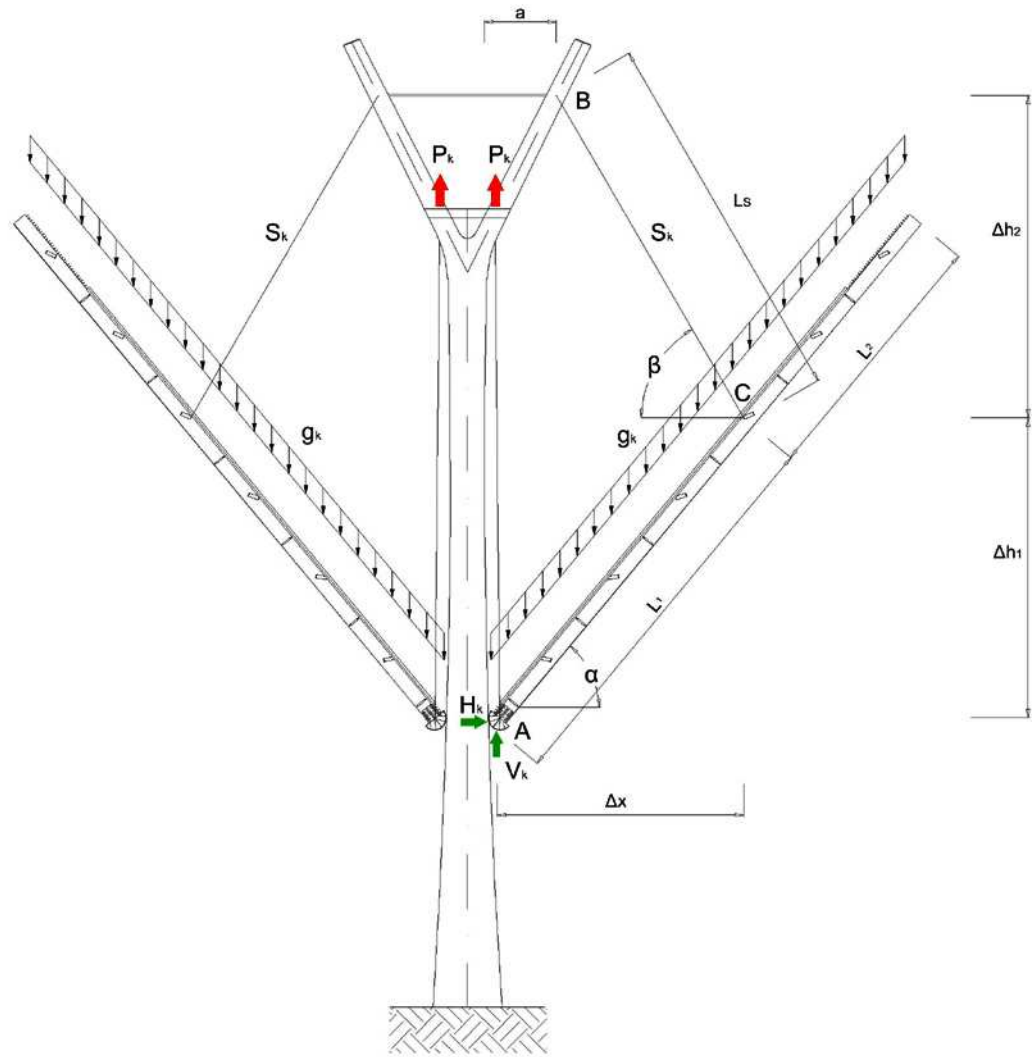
Bezeichnungen für die Berechnung der Montagekräfte
